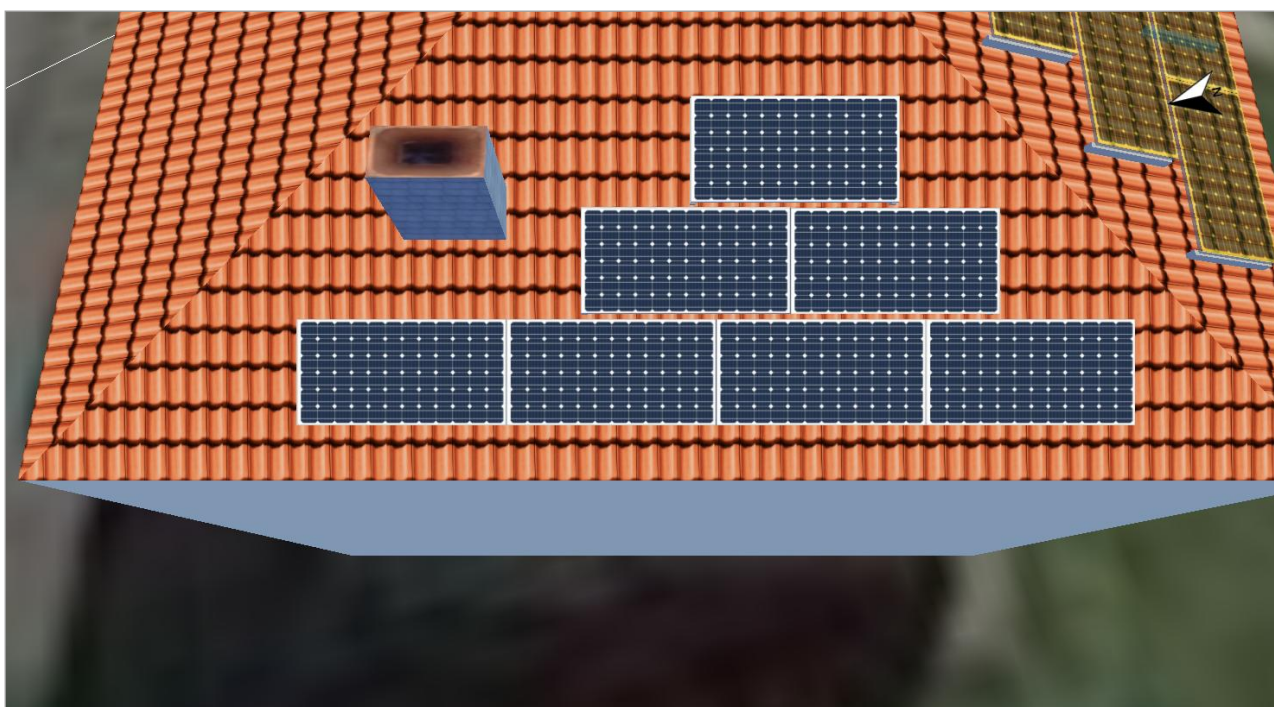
Plocha modulu - Vila-Roof Area South
